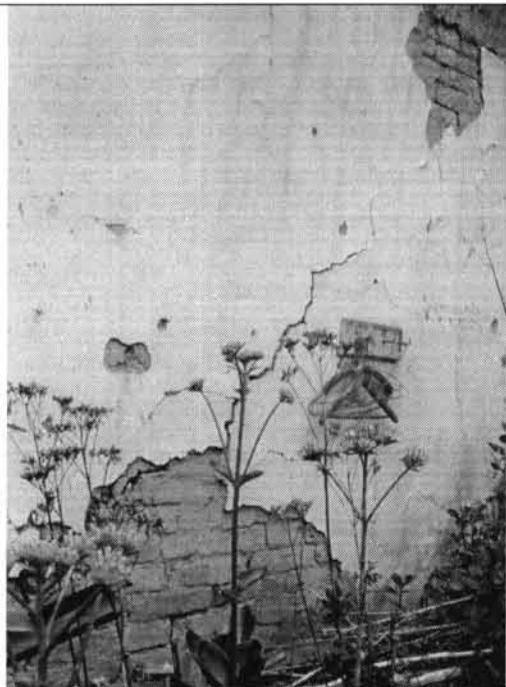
Detalle de grieta en muros del sector central y nororiental.
